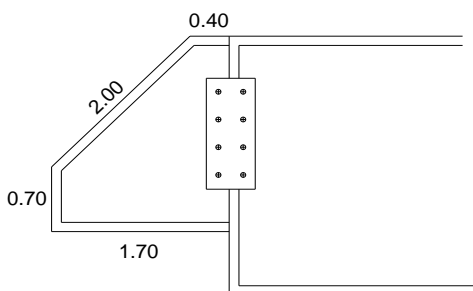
Extensión de vigas metálicas unidas con pernos para fácil armado
